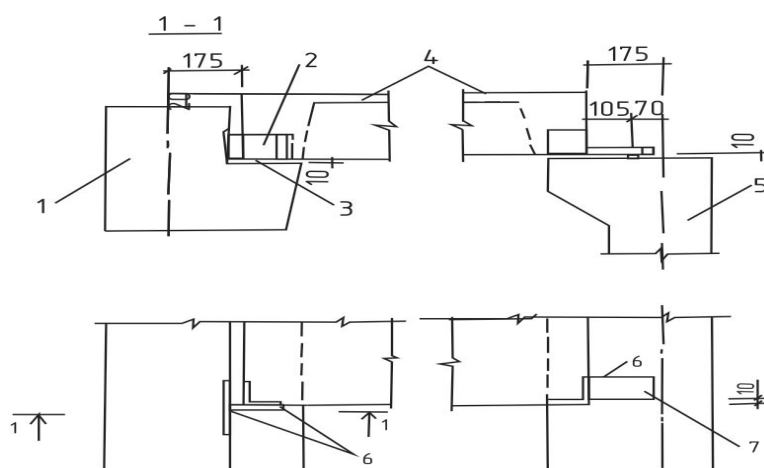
Крепление железобетонных лестничных маршей в каркасных зданиях
